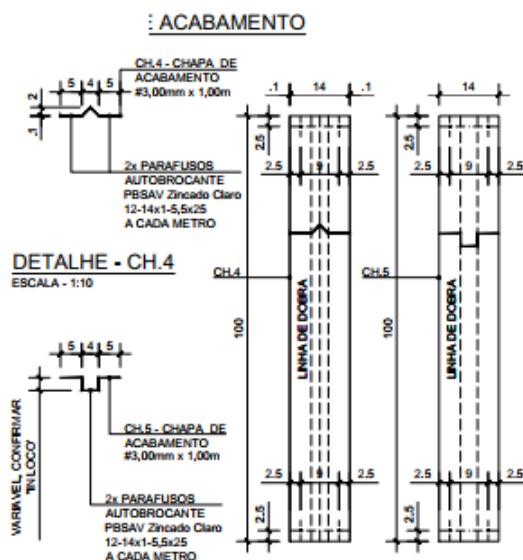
Elemento sugerido para arremate, vedação e fixação no apoio
